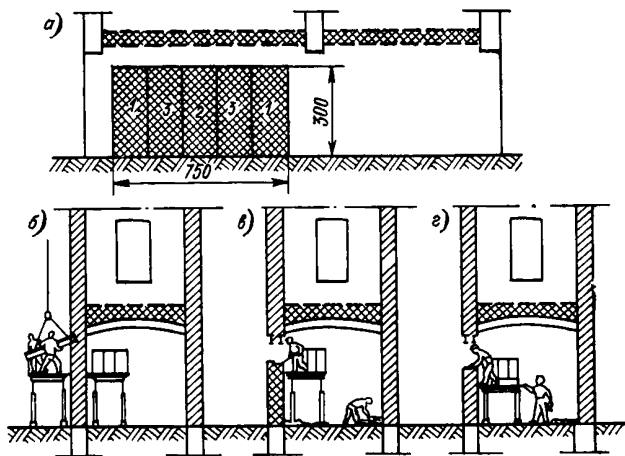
Общая схема организации работ по перекладке участка стены с сохранением вышележащей кладки
